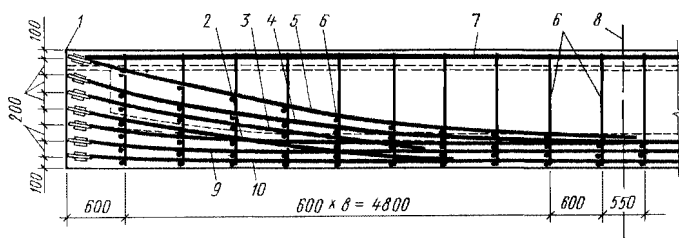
Отгибание на опорных участках элементов продольной предварительно напрягаемой арматуры: 1 – торец балки; 2, 5, 9, 10 – напрягаемые канаты или стержни арматуры; 6 – сетки для фиксации положения каналобразователей и напрягаемой арматуры; 7 – монтажная арматура; 8 – ось симметрии балки
